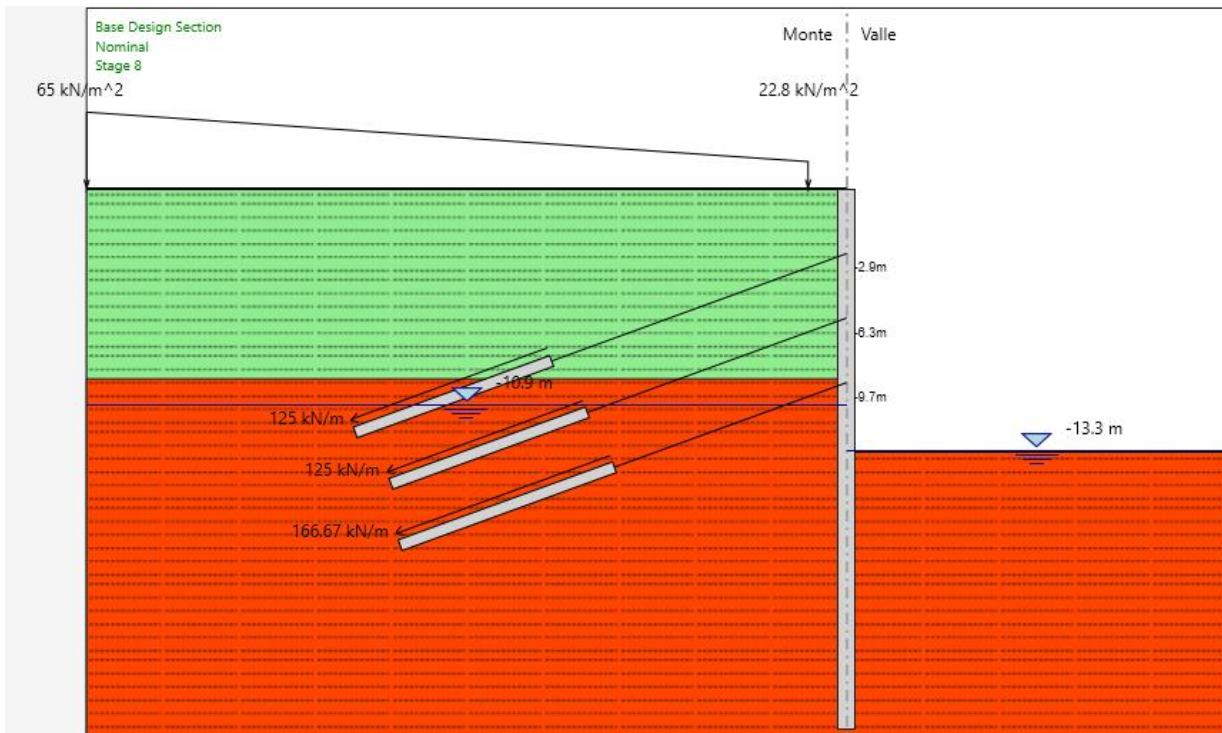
Sezione 2. Modello di calcolo - step finale di calcolo (fase 8)
